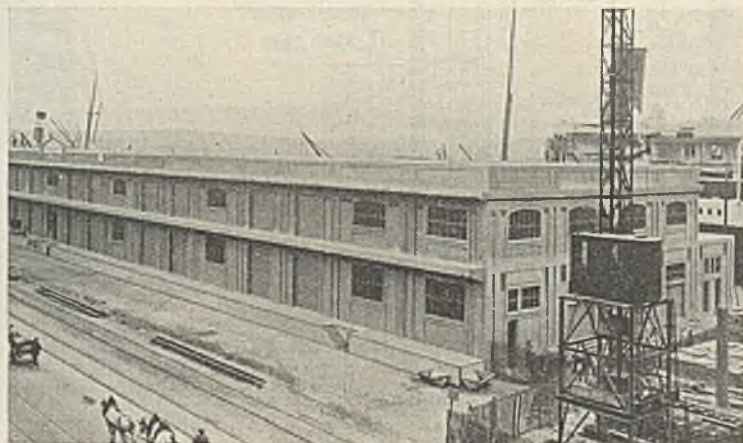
Bordeaux. Zweigeschossiger Eisenbetonschuppen am Quai de Bacalan (Ansicht von der Landseite).
